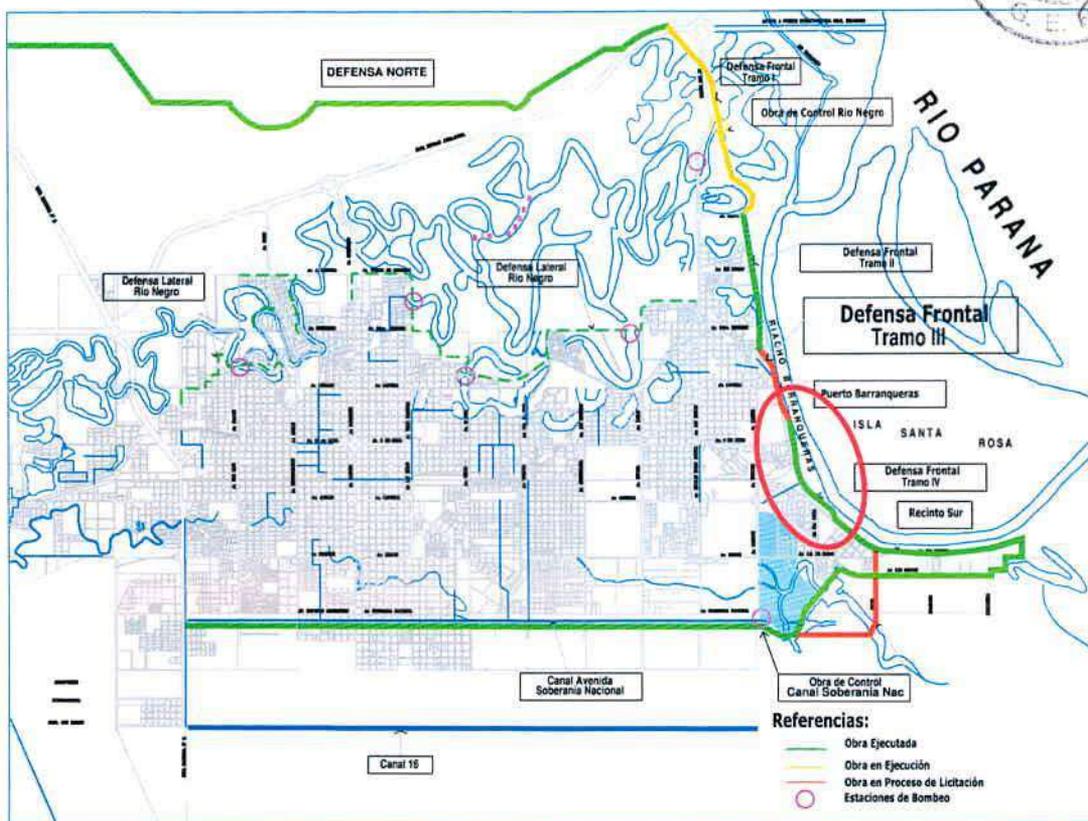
Y 2.17 - Traza de las defensas Definitivas del AMGR- fuente: Plan de Defensas
